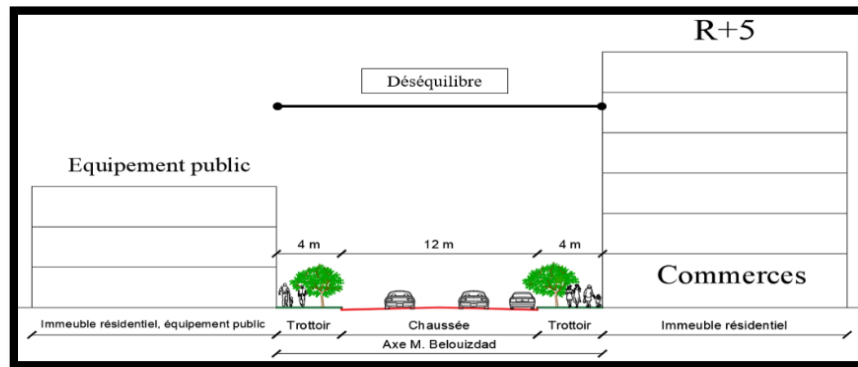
Coupe schématique rue Mohammed Belouizdad.
